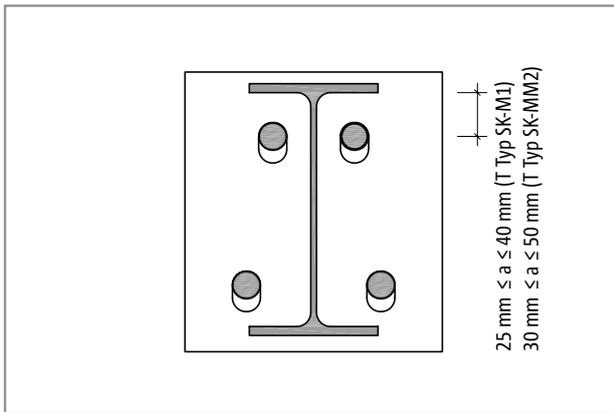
Schöck Isokorb® T type SK-MM2...-H200 : connexion de la plaque frontale au support IPE220
